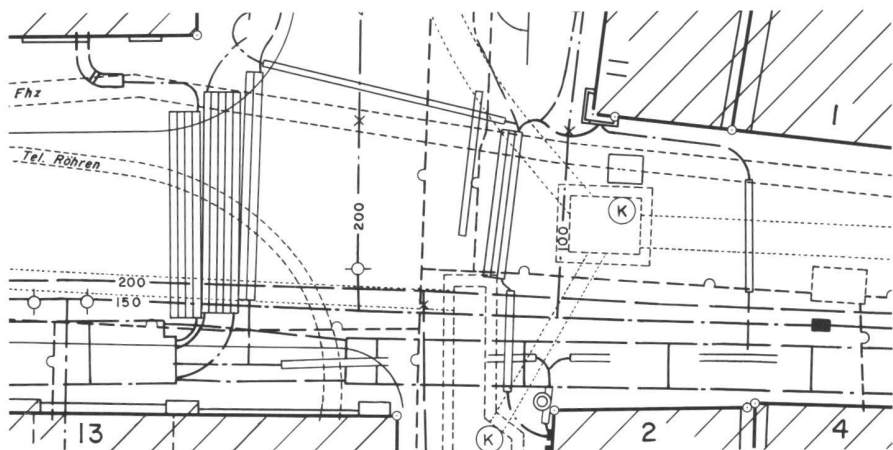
Leitungskatasterplan 1:200 mit digitalem Grundplan und Schraffur auf Deckfolie
